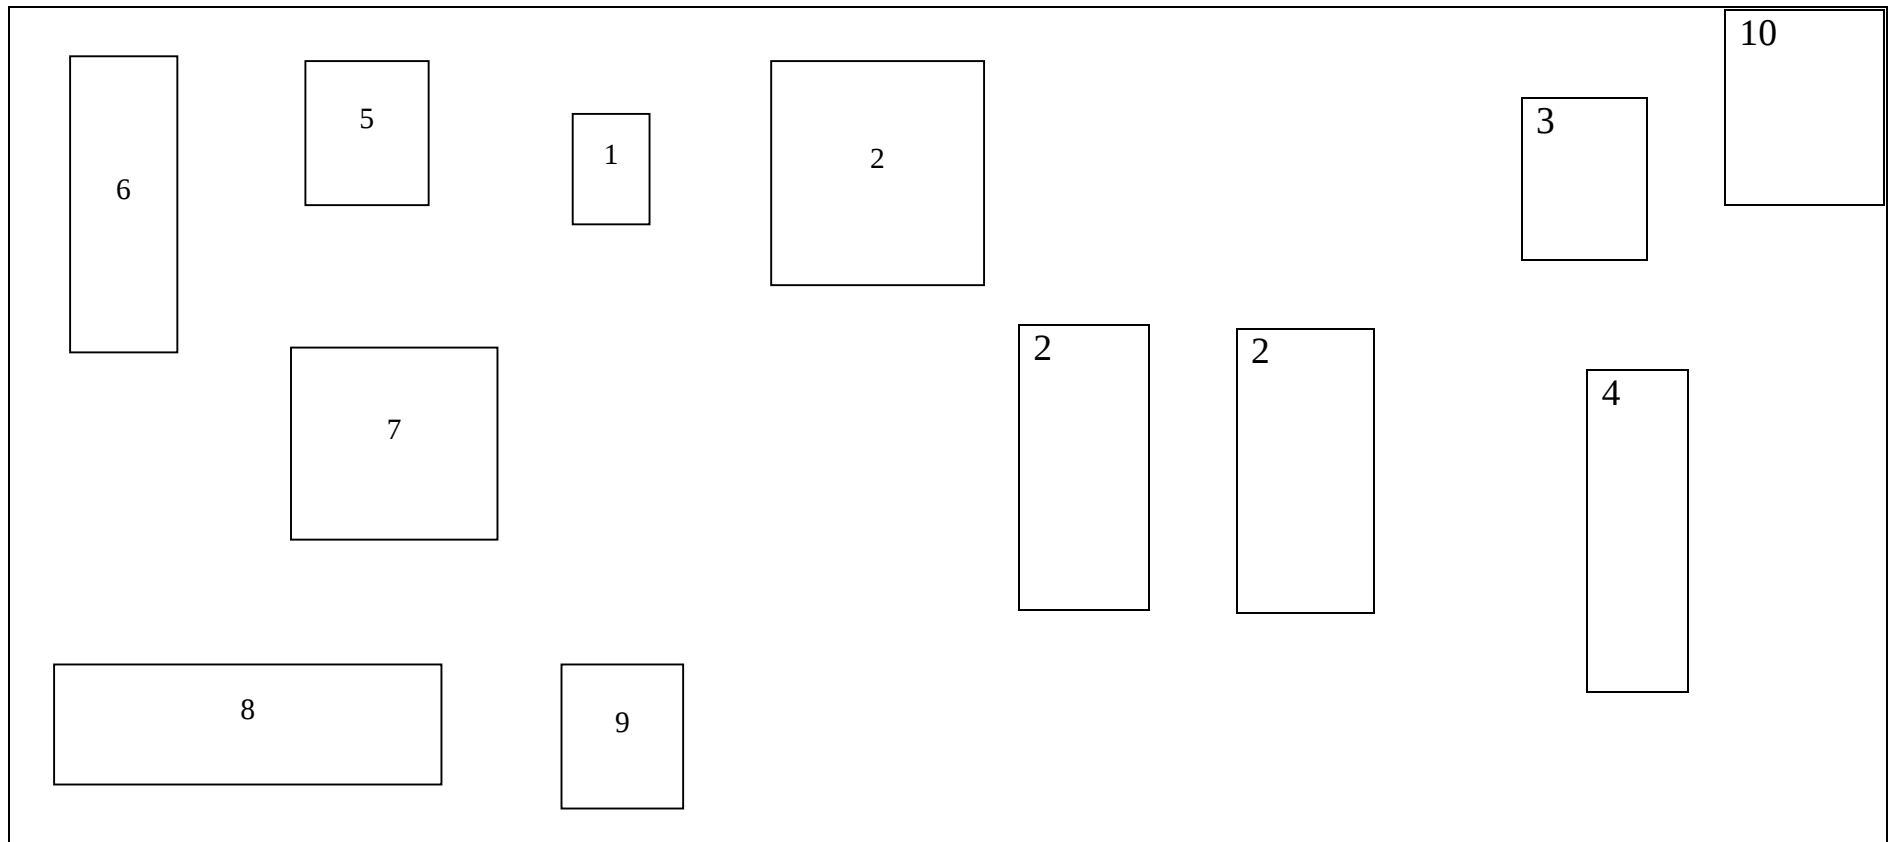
Схема генерального плану свинотоварної ферми «Трофімова»
